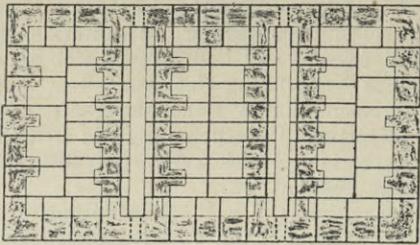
Block mit hinteren Baulinien, sowie Anordnung von Wohnhöfen mit Durchgangsstraßen. 1:4000
